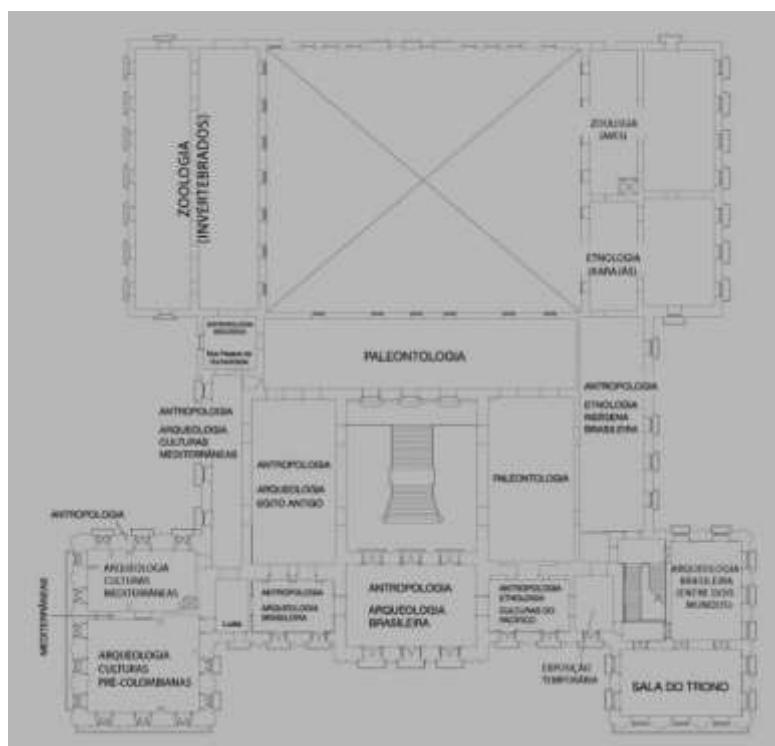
Planta do primeiro pavimento das exposições do Museu Nacional.
